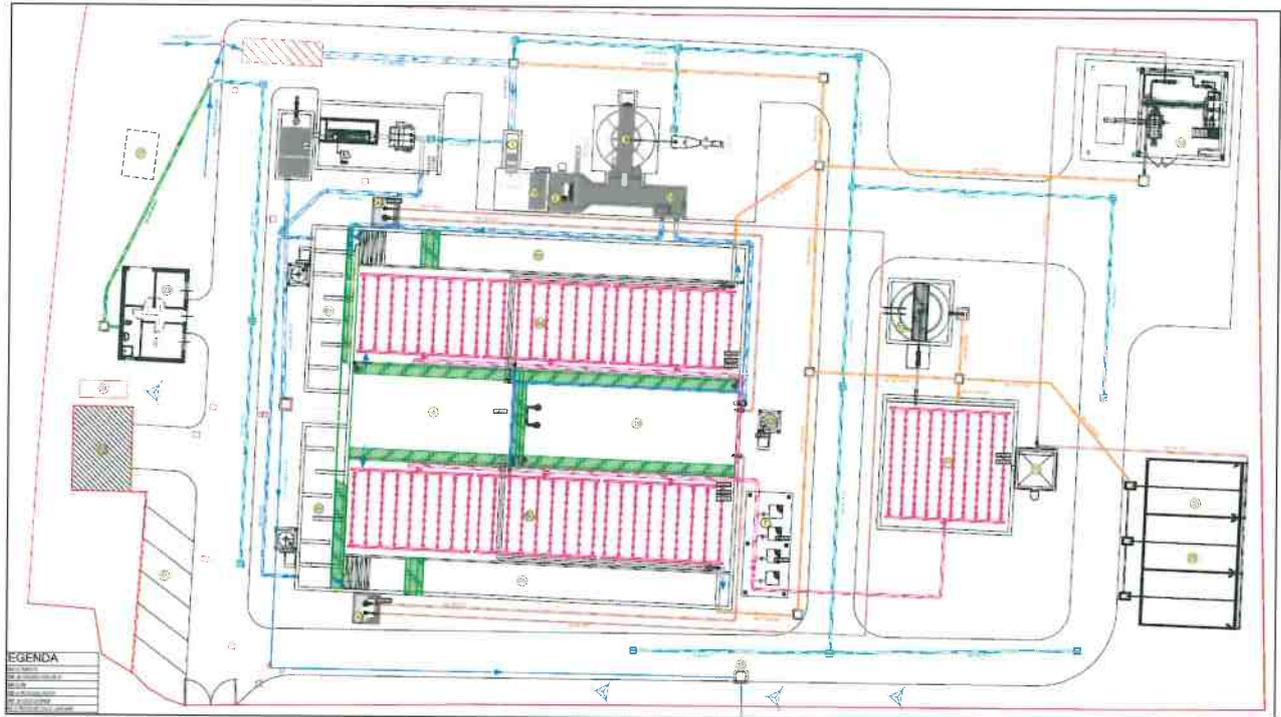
Planimetria stato di progetto (da Tav. B1-06 allegata allo SPA)
